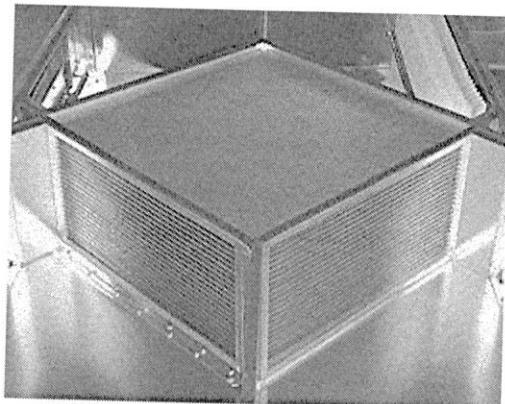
Пластинчатый рекуператор приточно-вытяжной установки
